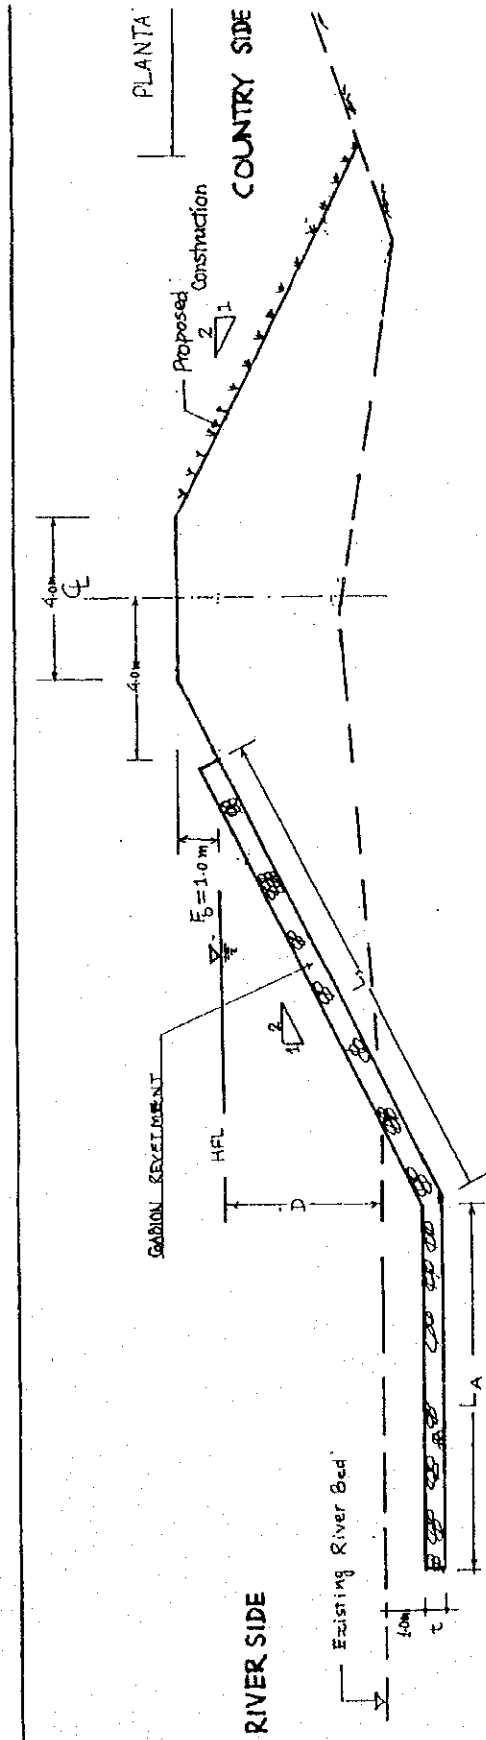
マハカリ川河川改修(ドダラ・チャンダニ地区)計画平面図
